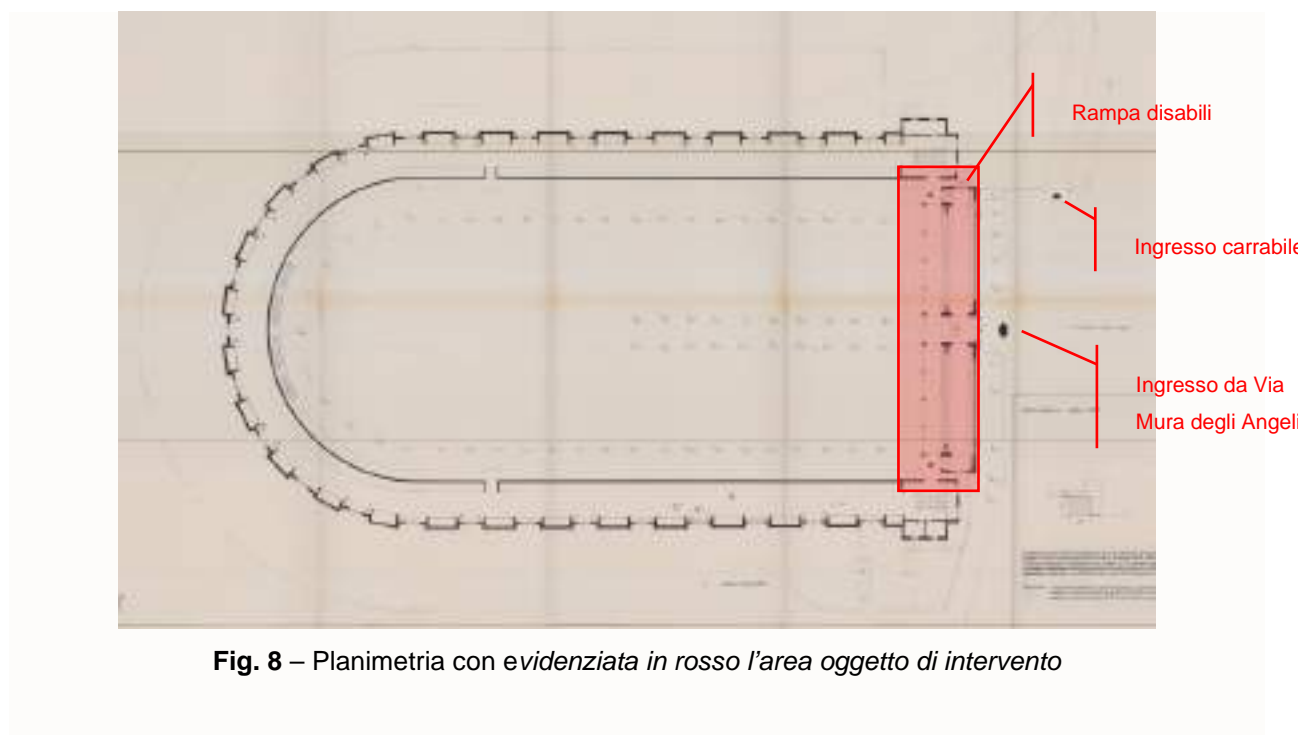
Planimetria con evidenziata in rosso l'area oggetto di intervento
